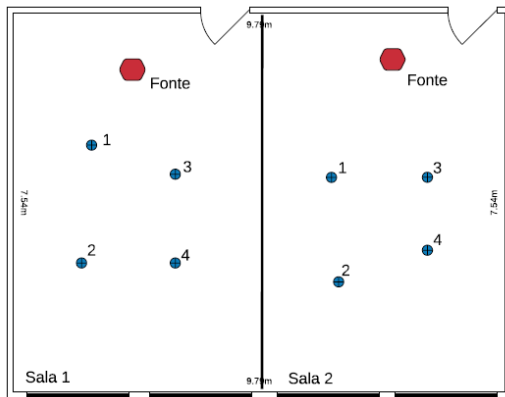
Planta baixa, com indicação do posicionamento da fonte e receptores, das Salas 1 e 2, separadas por uma parede lateral removível. (Os autores, 2018).
